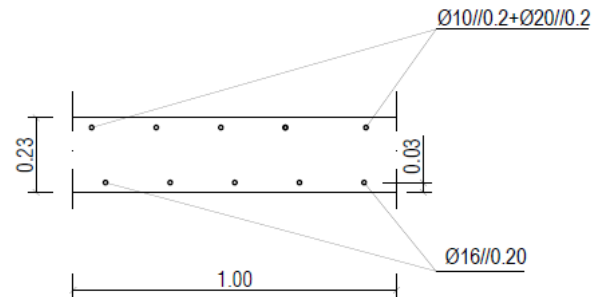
Secção transversal da Zona de Apoio para direção X
